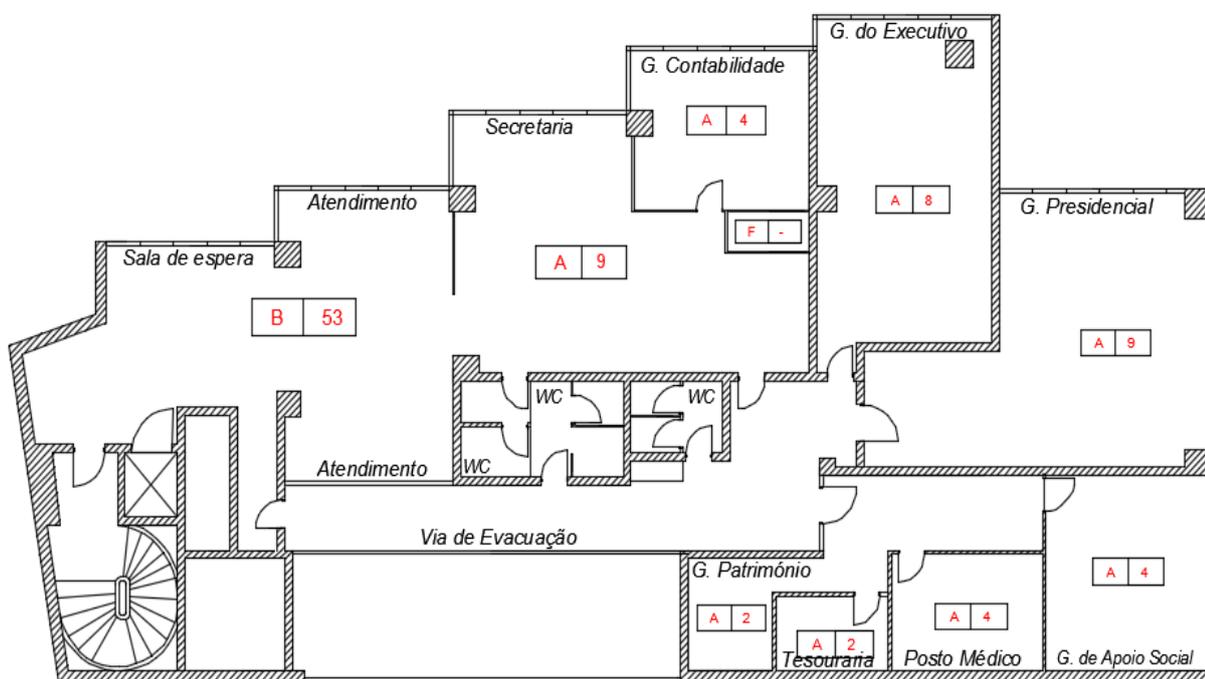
Planta do 1º piso – Local de Risco e efetivo
